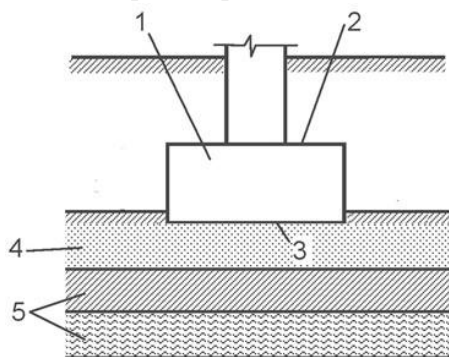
Схема фундамента и его основания: 1 – фундамент; 2 – обрез фундамента; 3 – подошва фундамента; 4 – несущий слой; 5 – подстилающие слои (по Федулов, Артемова, 2015)
